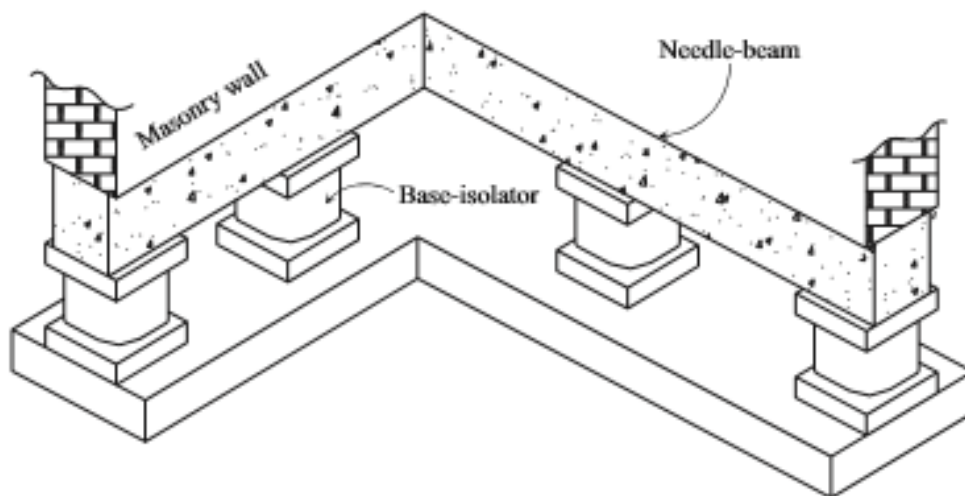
Isolamento de base em estruturas de alvenaria (Matsagar & Jangid, 2008)
